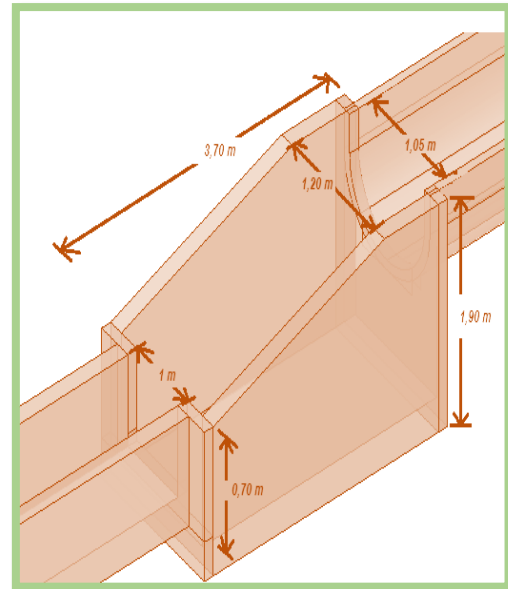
Canal con sección trapezoidal de la infraestructura hidráulica de riego Oidor.
